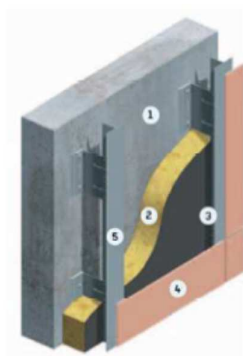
Esquema de Construção em Tabique Pluvial. Fonte: (Poyatos, La fachada Ventilada, 2010).
